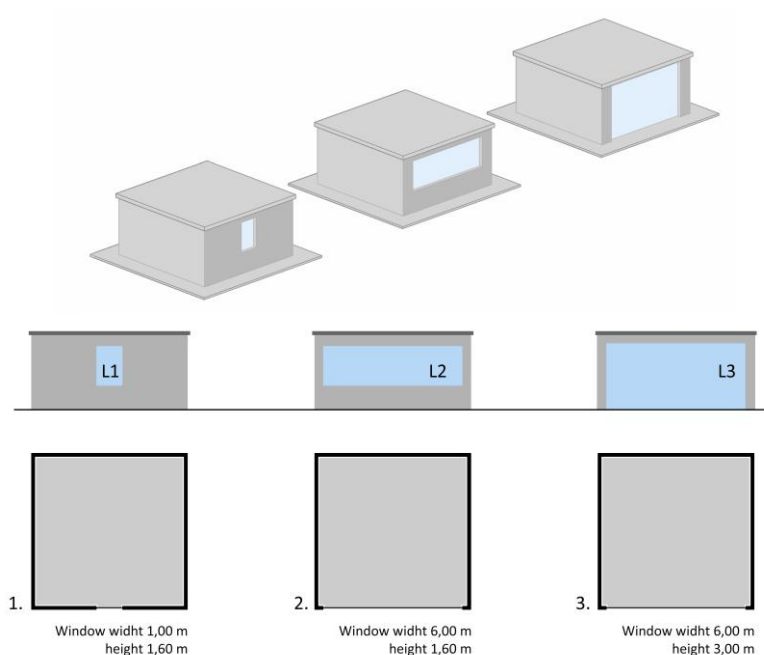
Vista isometrica, pianta e sezione dell'ambiente considerato con indicate le dimensioni delle aperture considerate
